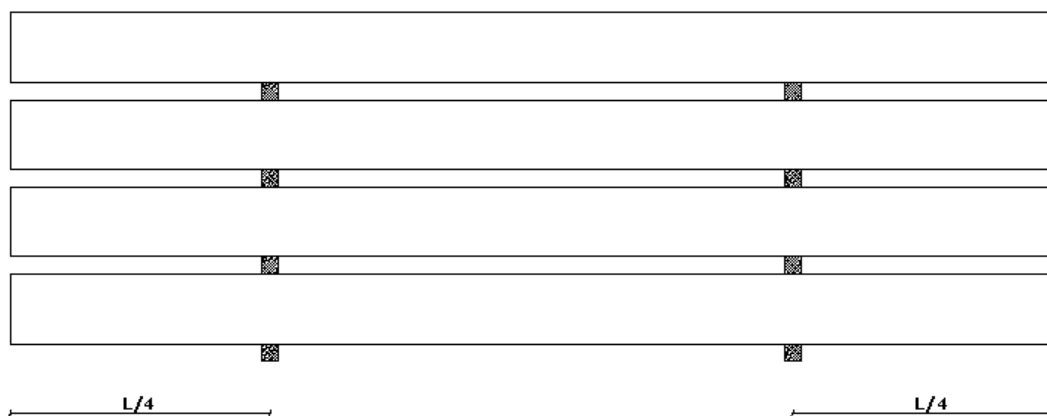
Disposição dos barrotes de madeira em vista lateral.
